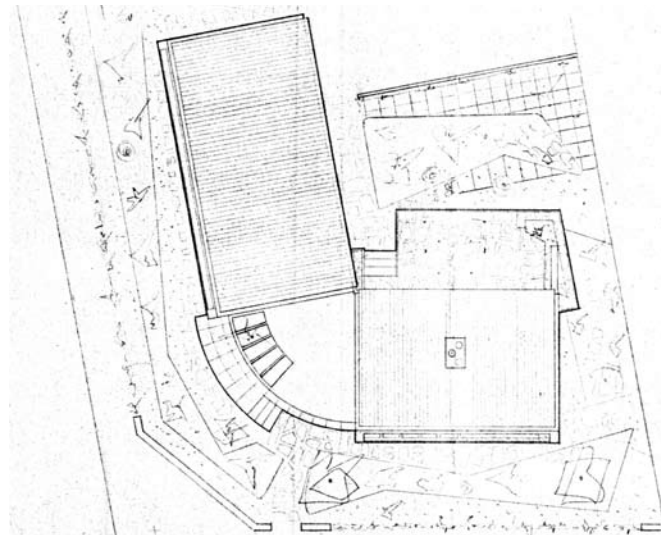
Casa José Malta, António Baroseiro, 1956. Planta de cobertura.
